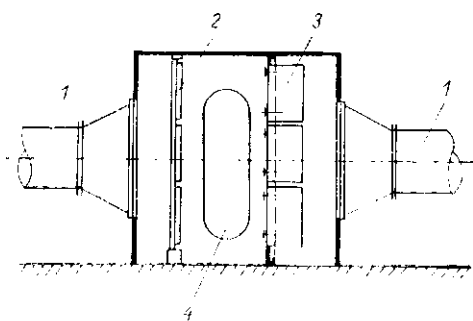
Установка для очистки воздуха от аэрозолей свинца
